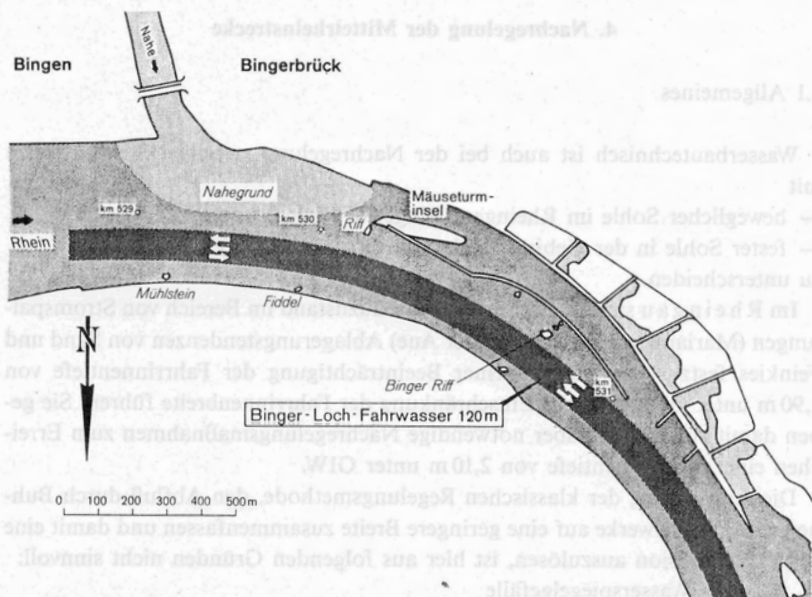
Binger-Loch-Strecke – Zustand nach dem Ausbau mit geplanter Nachregelung
